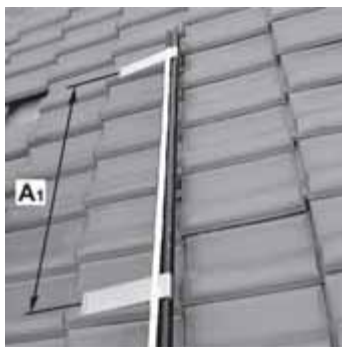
Posizionare il gancio di fissaggio per collettori
